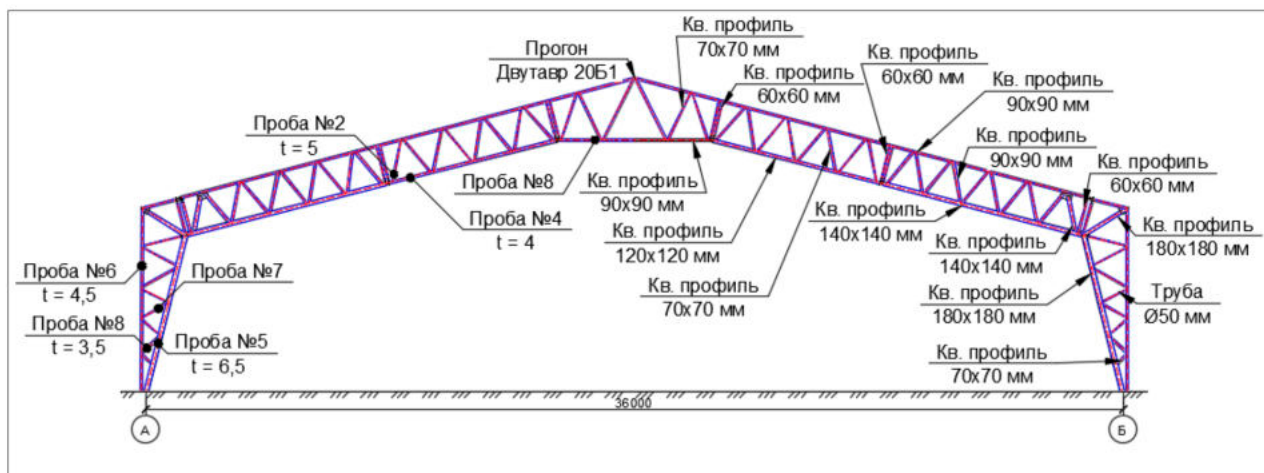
Схемы расположения мест отбора проб металла с несущих конструкций рам каркаса.
